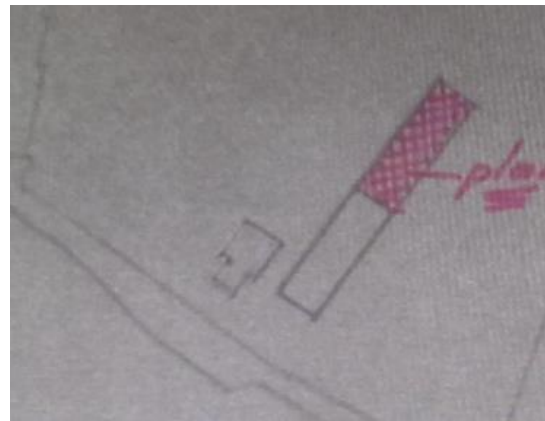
Ligging opfokhok uit 1968 en de uitbreiding uit 1969
